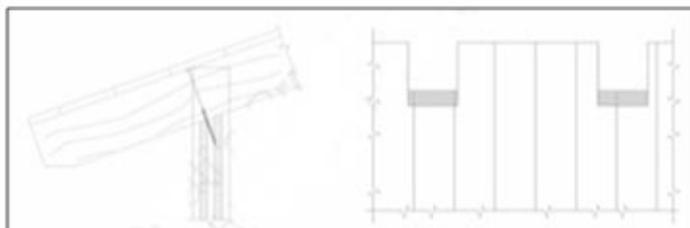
Collegamento parte - copertura del tipo tradizionale.
